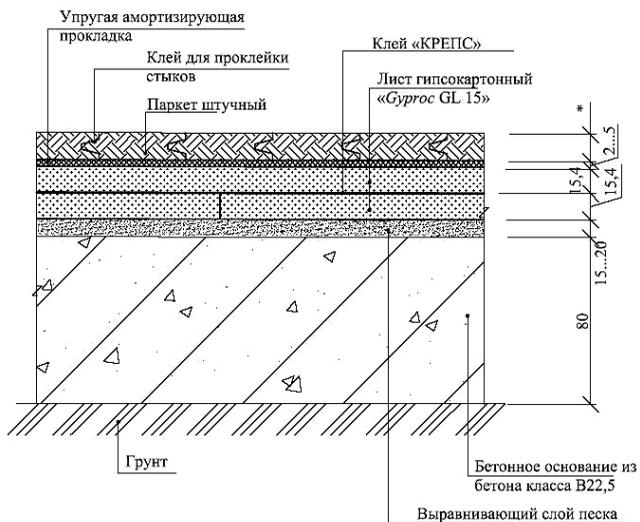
Пол на бетонном основании с покрытием из паркетной доски
